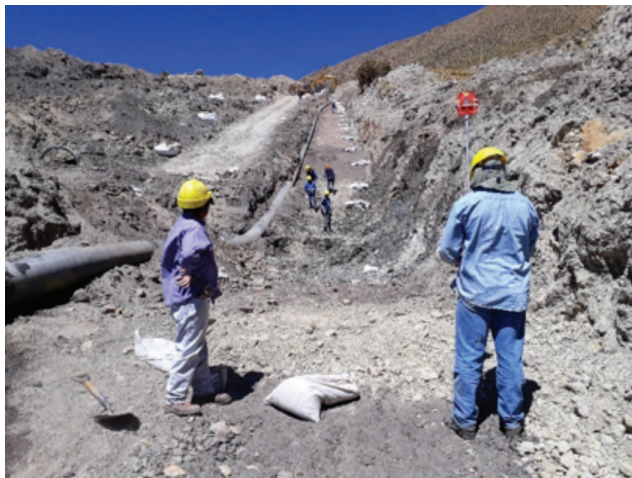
Equipo de topografía indicando la posición de las bolsas en el terreno.
